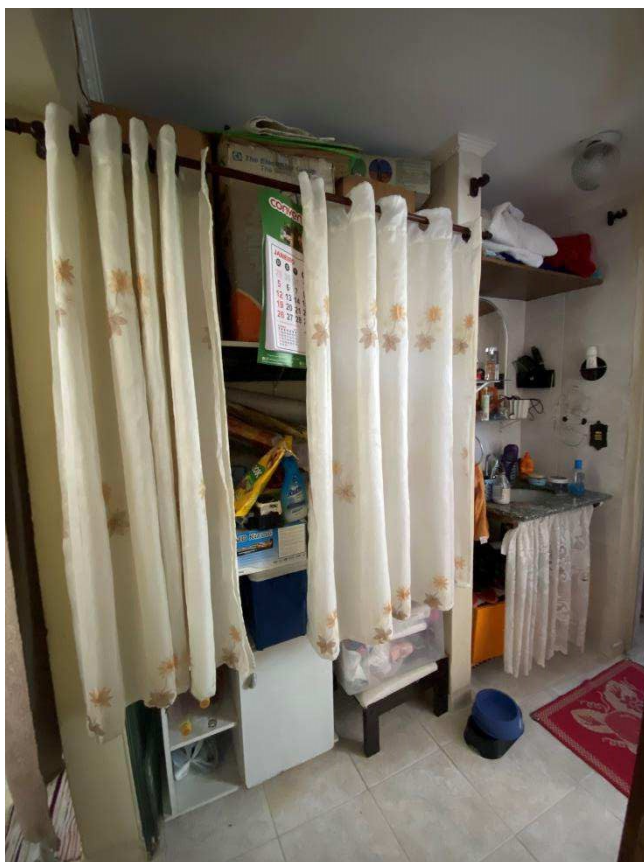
Vista do corredor dos quartos. Pia locada fora do banheiro.
